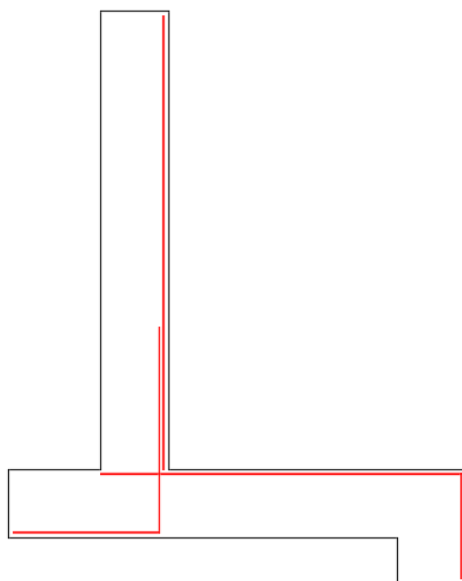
SEZIONE TIPO POSIZIONE ARMATURE TESE
